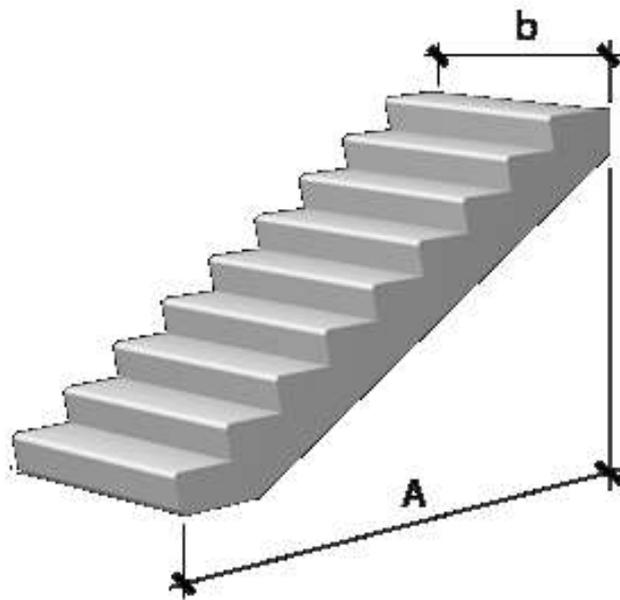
Лестничный марш для зданий жилищного назначения
